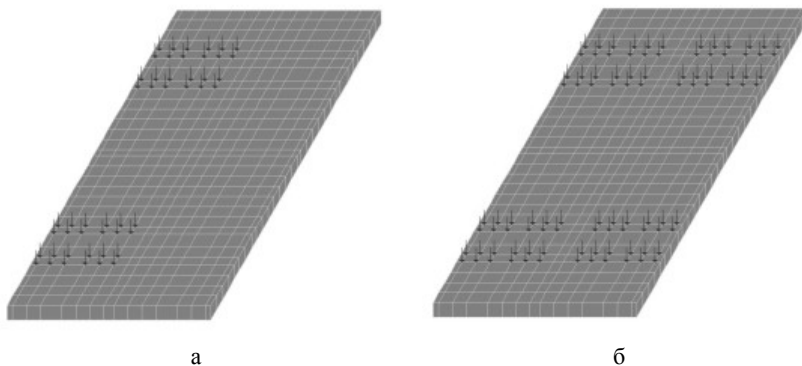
Розташування навантажень на верхню будову шляху: а – у випадку 1-ї схеми навантаження; б – у випадку 2-ї схеми навантаження.
